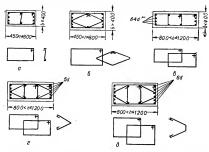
95. Армирование колони хомутами и конструктивной продольной арматурой:
